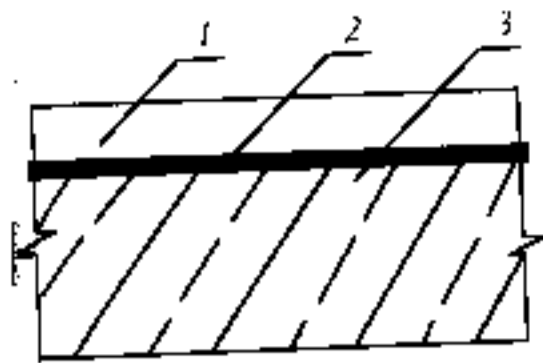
1 - паркетная доска фирмы «Junckers»; 2 - звукоизоляционная мата; 3 - железобетонная плита перекрытия
